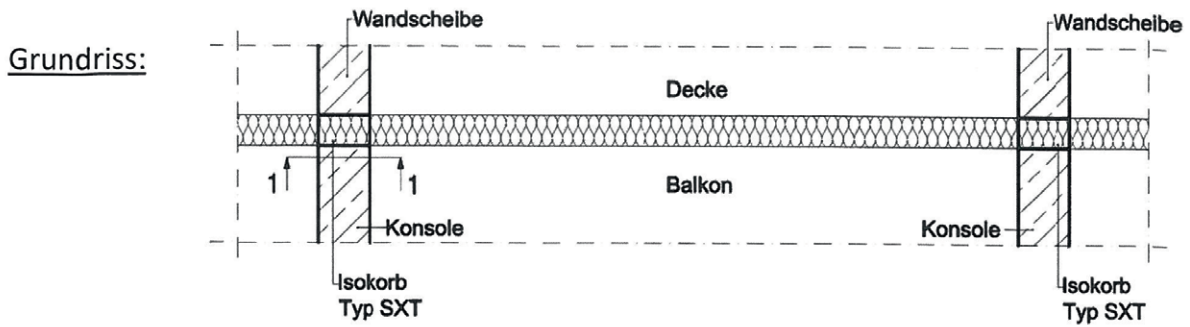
Einbausituation Schöck Isokorb Typ SXT
